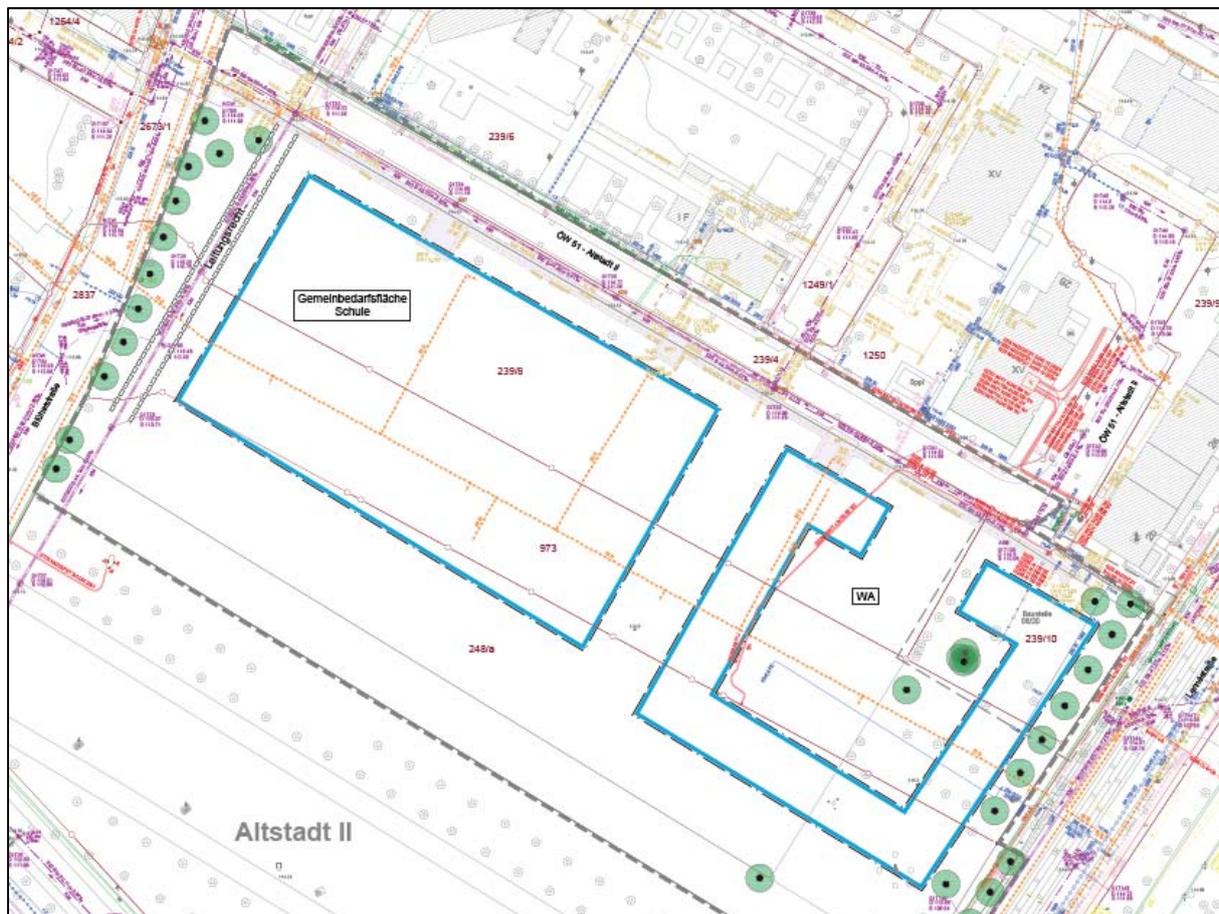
Planauszug aus dem Lageplan Medienbestand zum Bebauungsplan 389 C, Stand September 2022
